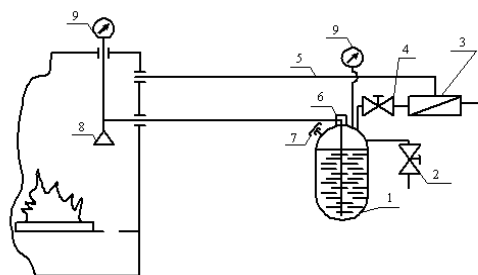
Принципова схема системи пожежогасіння інертним газом (інгібітором горіння): 1 – резервуар; 2 – клапан вентиляції; 3 – автоматичний редуційний клапан; 4 – запірний клапан; 5 – імпульсний трубопровід; 6 – головка-затвор ГЗСМД; 7 – заправочний штуцер; 8 – розпилювач РЦ; 9 – датчик тиску
